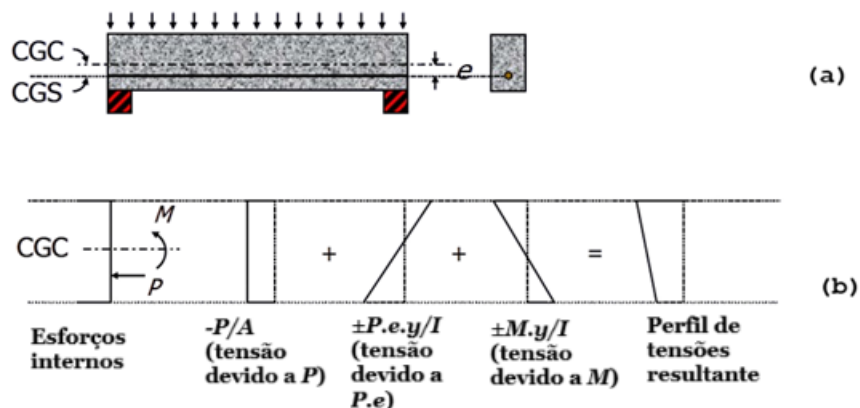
Viga simplesmente apoiada sob uma carga uniformemente distribuída (a); Estado de tensão na viga devido aos esforços internos (b) [7] (adaptado).
